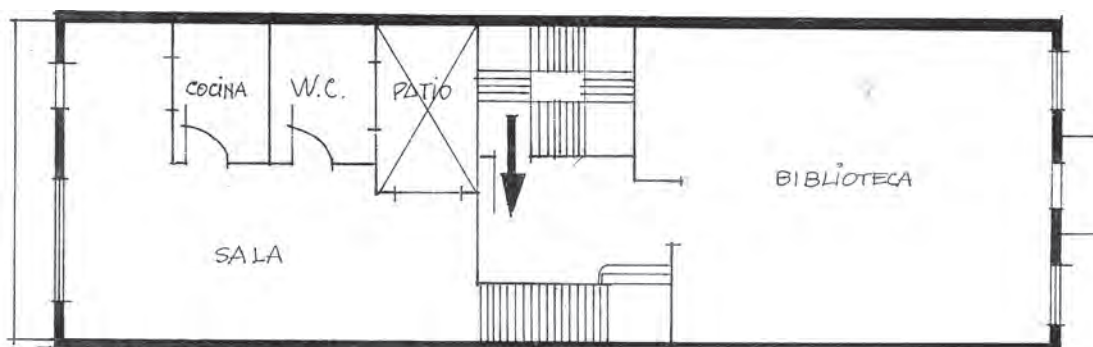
18. 1984. PLANO DE LA 3ª PLANTA DESPUÉS DE LA REFORMA
